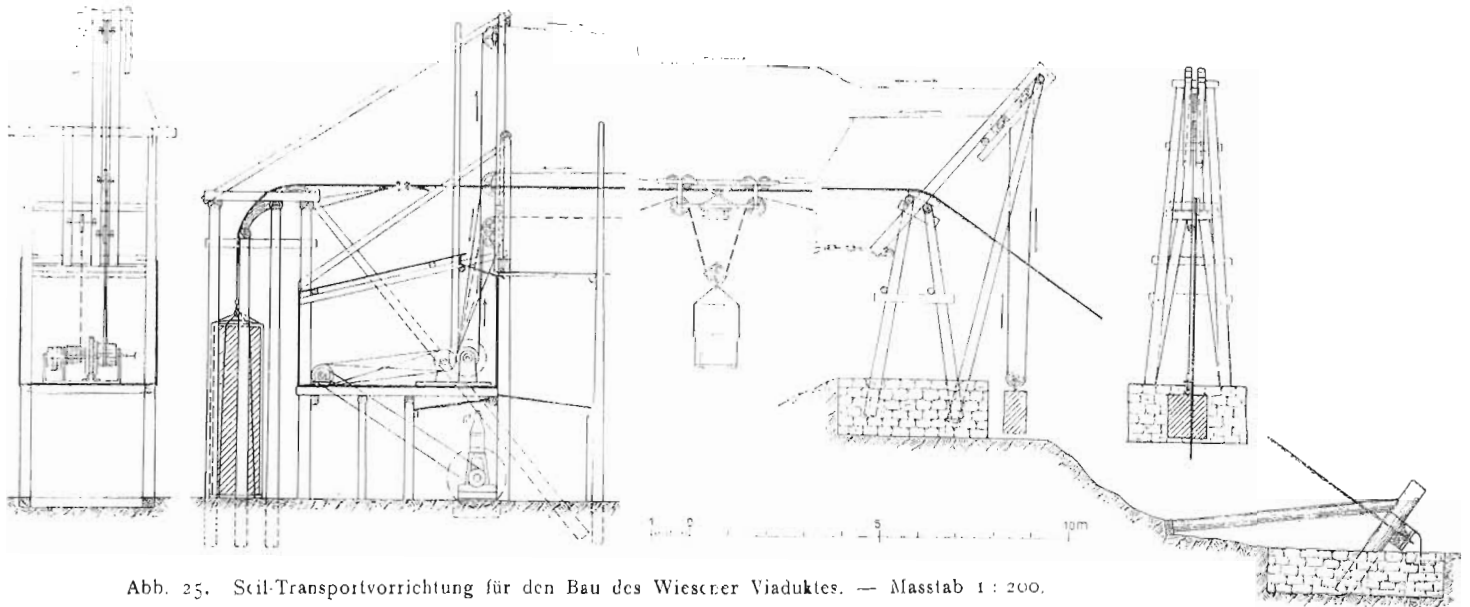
Seil-Transportvorrichtung für den Bau des Wiescher Viaduktes. — Masstab 1 : 200.
